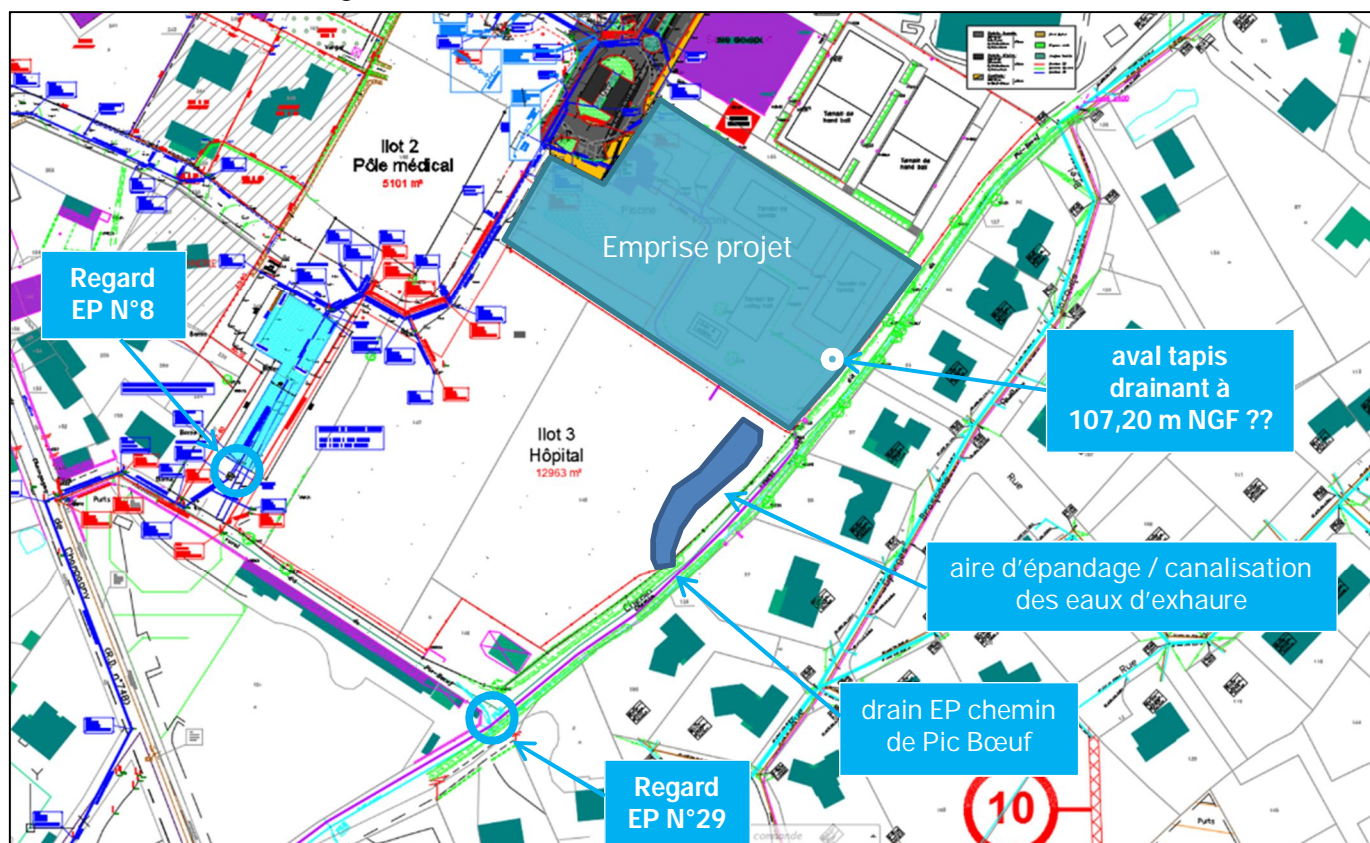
Localisation des regards EP N°29 et N°8 - Extrait du plan de recollement des réseaux
